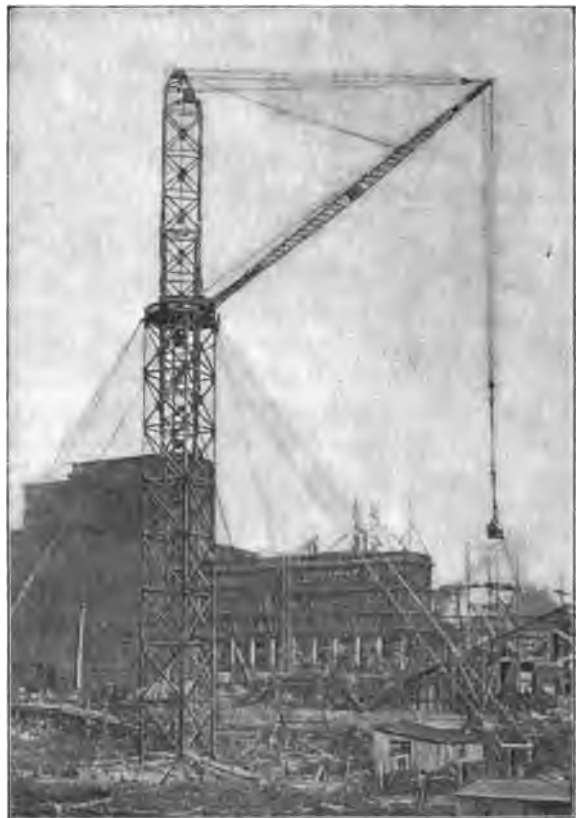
40 m hoher und 26 m ausladender Schwenkkran beim Bau des Warenhauses Ward & Co. in Chicago.
